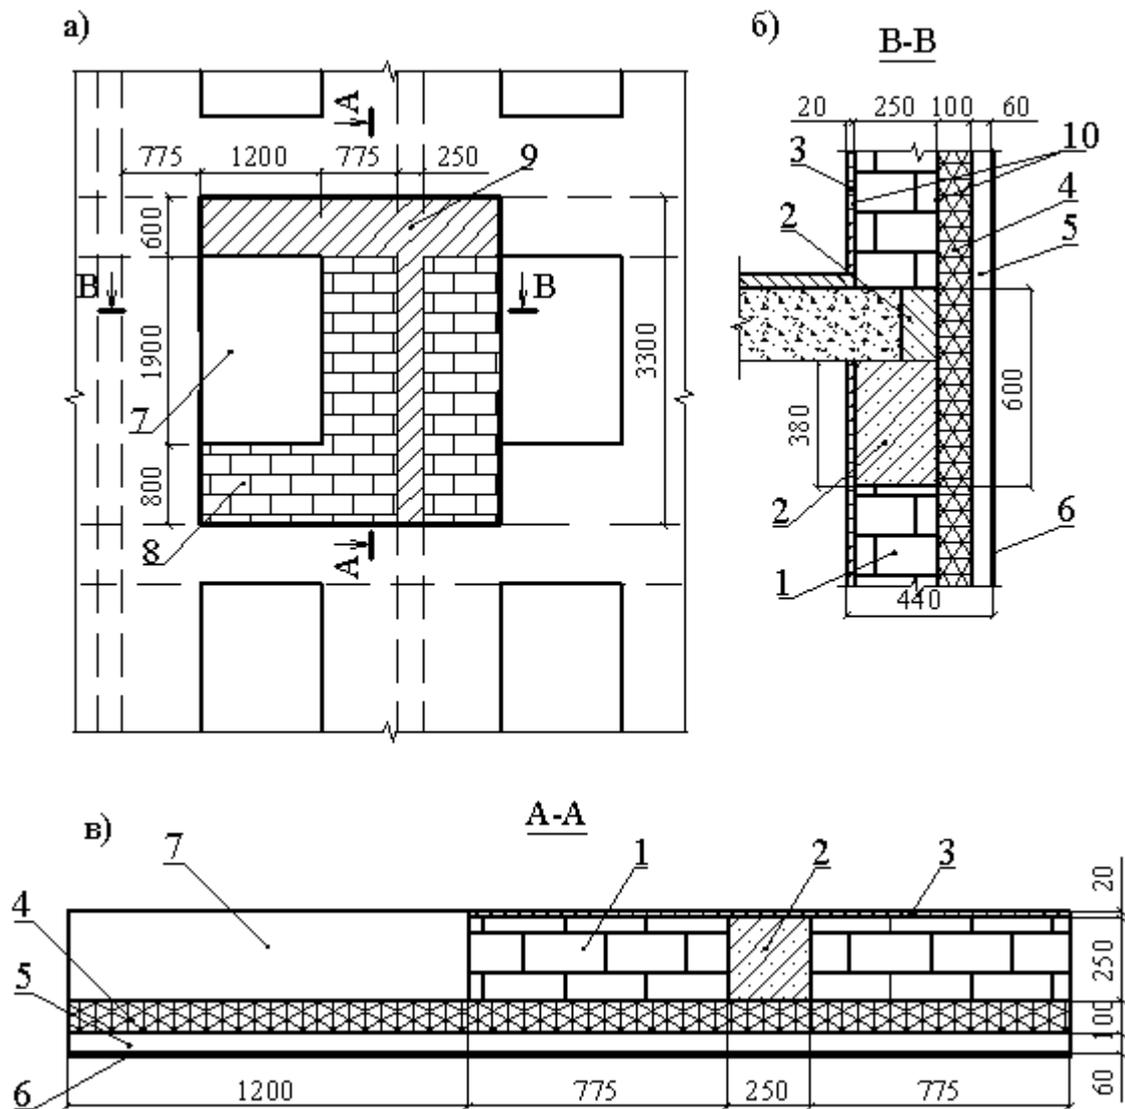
Модульный фрагмент фасада здания (а) и его сечения А-А (б) и В-В (в)
